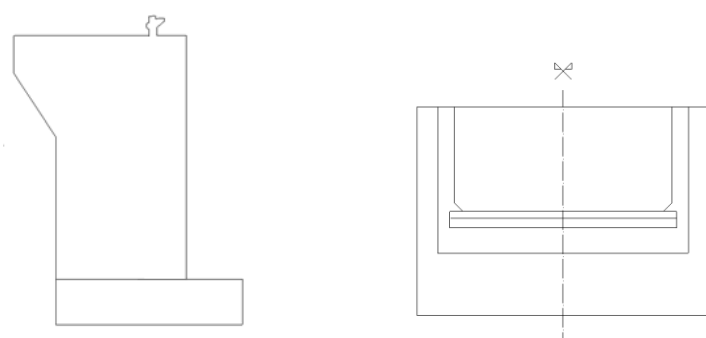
a. Esquema del perfil y la planta de estribos y cimentación
